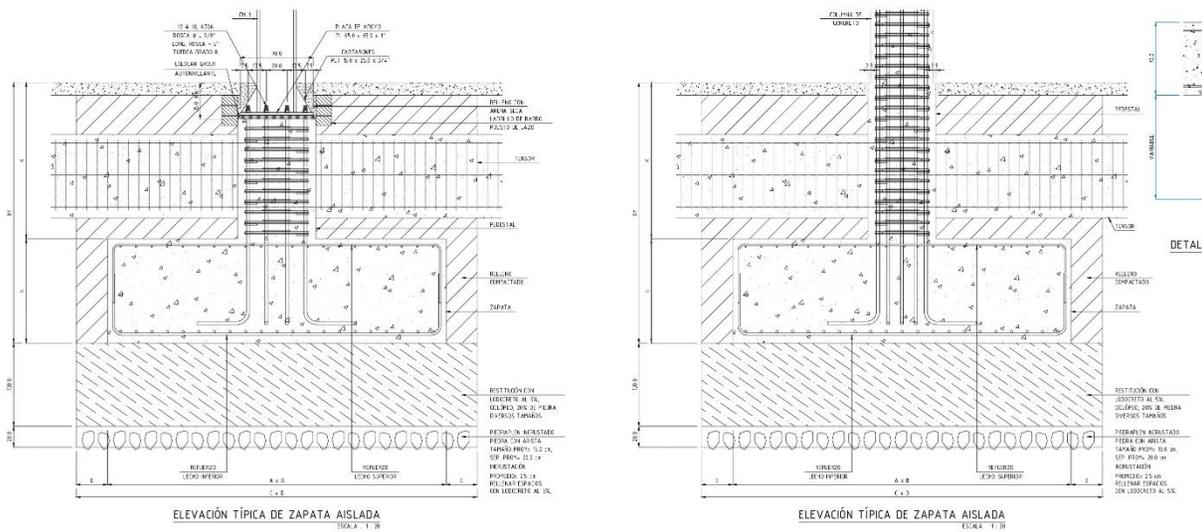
DONDE SE OBSERVA LAS ZAPATAS AISLADAS PROPUESTAS EN EL PROYECTO.
